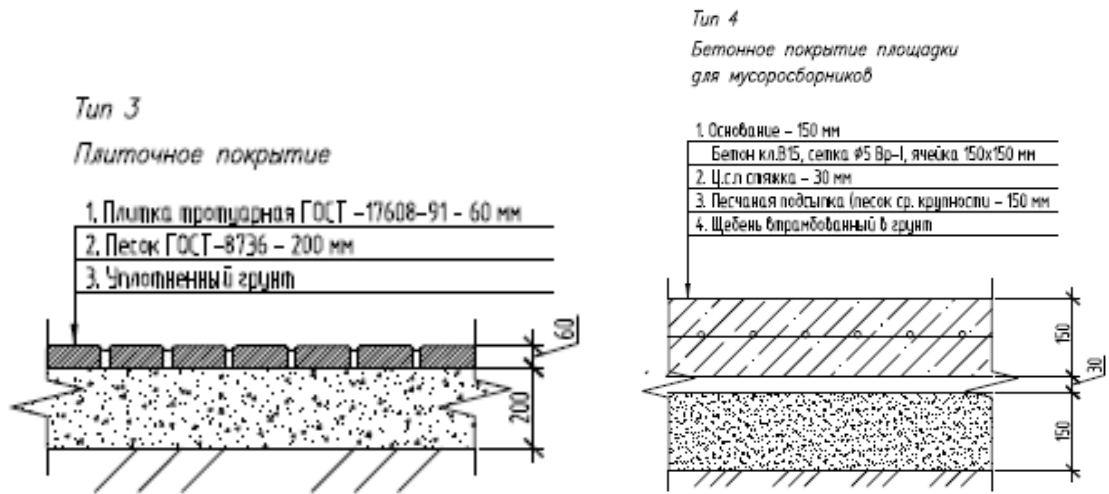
Плиточное покрытие. Бетонное покрытие площадки для мусоросборников
